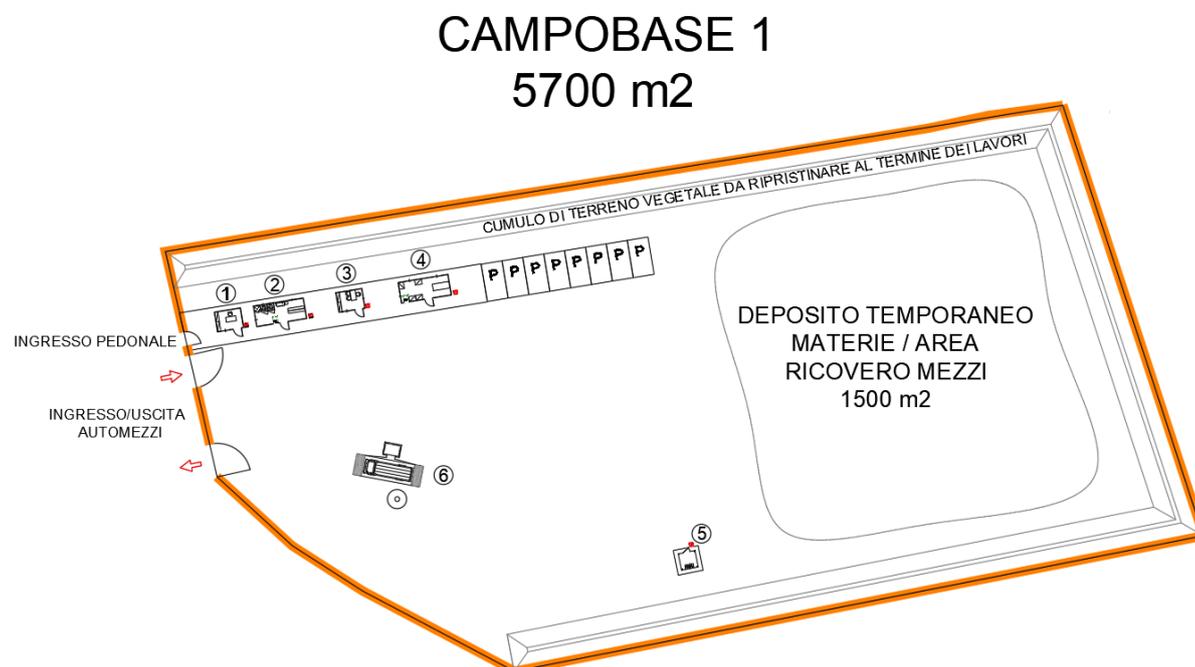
Layout di cantiere – Campo Base 1, a servizio delle tratte 1 e 2.
